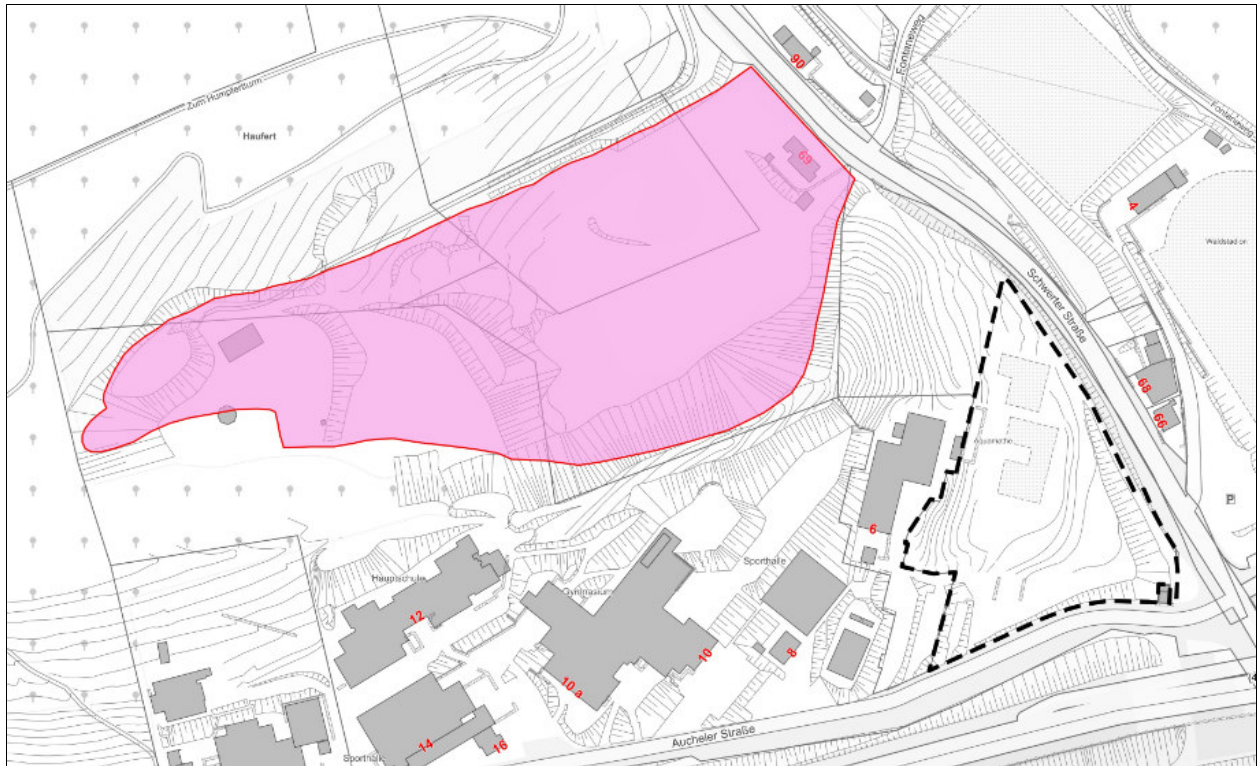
Lageplan mit Darstellung der benachbarten Altlastverdachtsfläche
